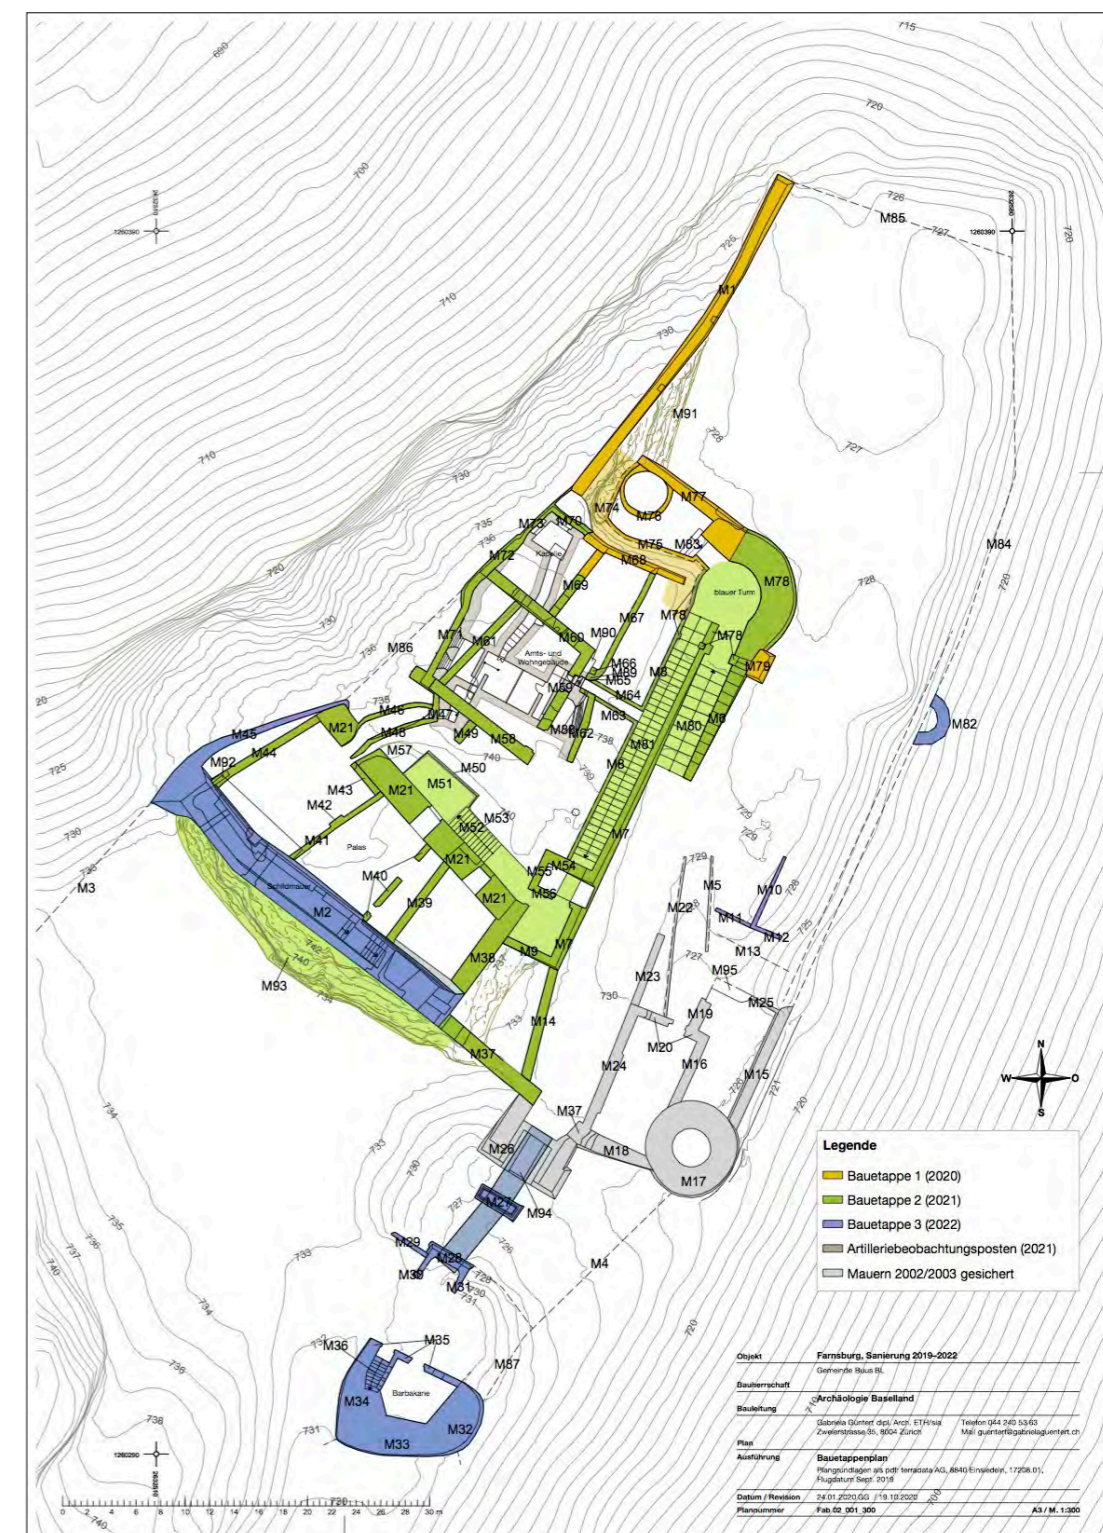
Farnsburg, Grundriss mit Mauernummerierung sowie der Unterscheidung der Sanierungsetappen 2020–2022
